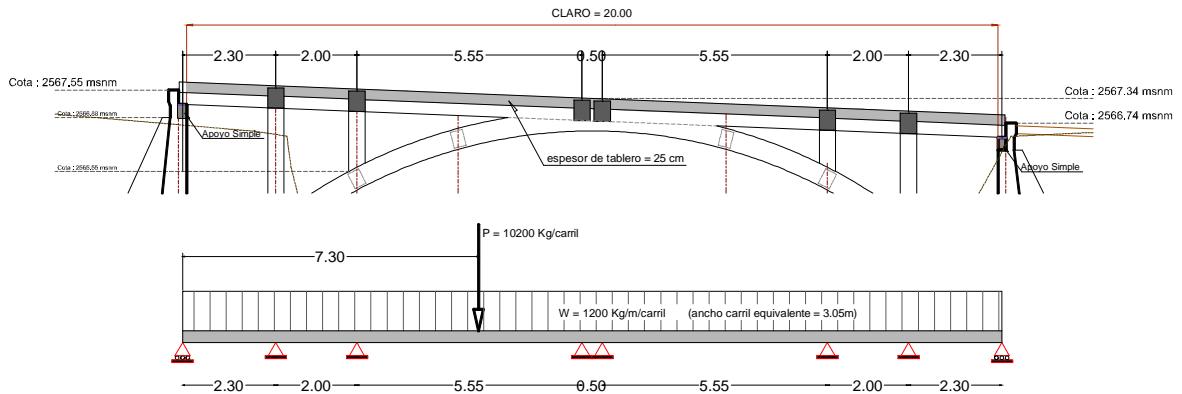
Tablero con Carga Equivalente – Modelo Viga Continua AUTOR Pedro Hurtado L.
